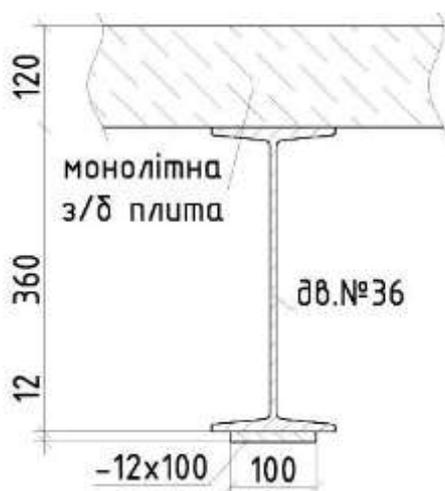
Поперечний переріз типових вбудованих СЗБ перекриттів
